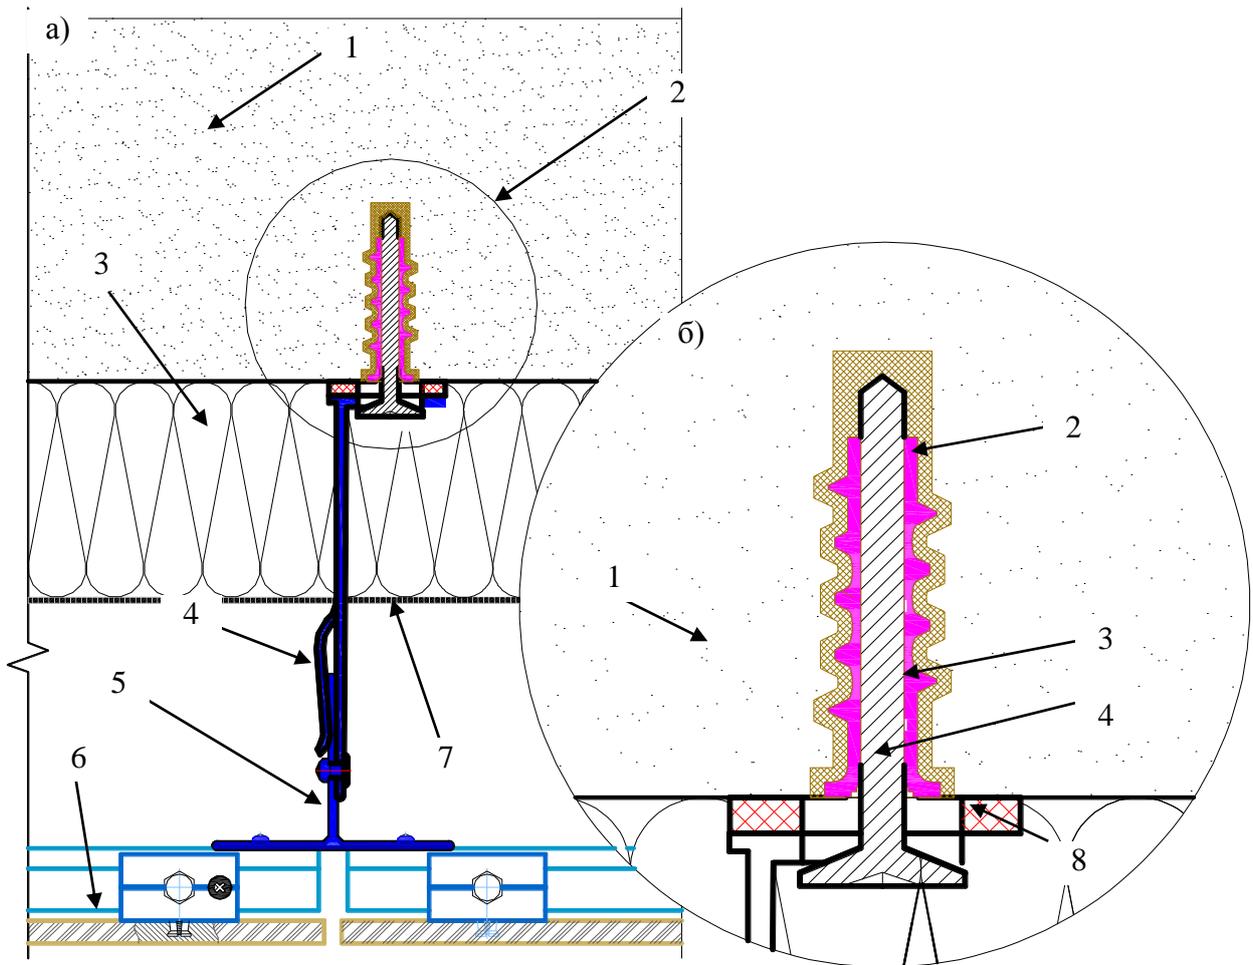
Принципиальный узел крепления НВФ на ограждающую конструкцию из газобетонных блоков с помощью усовершенствованного анкерного крепления.
